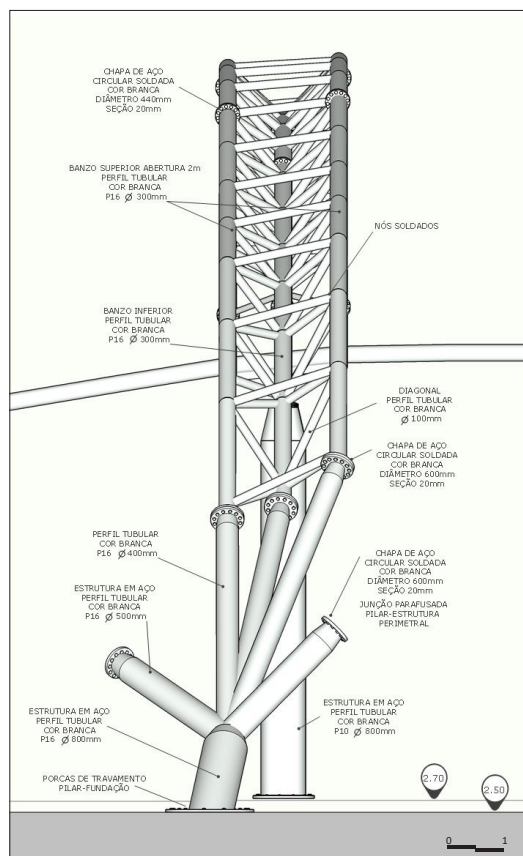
Detalhamento treliça 03. Elevação sudoeste. Planta técnica anexa em escala 1:50. Rafael Rodamilans, 2018
